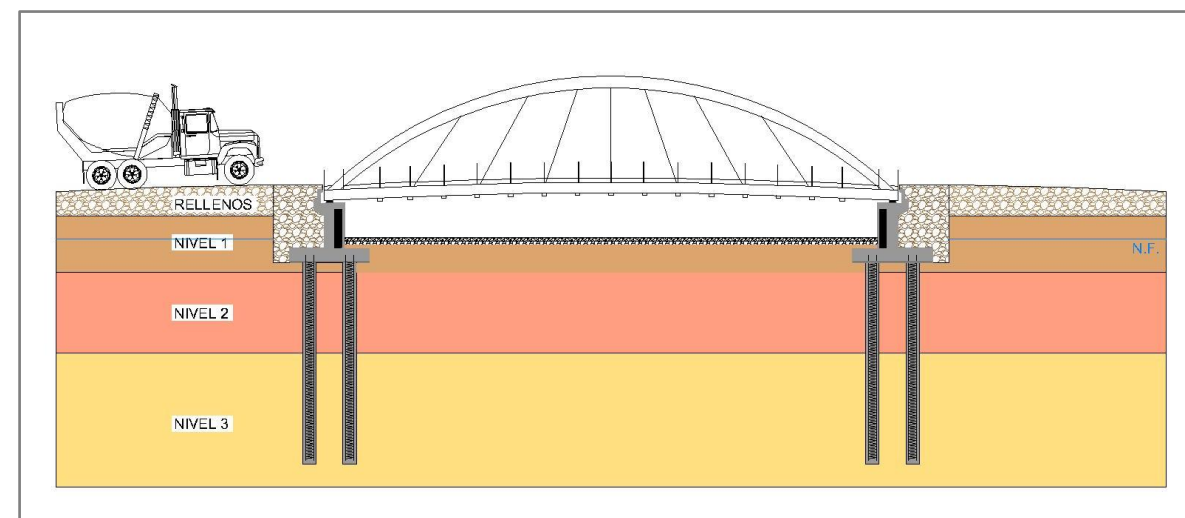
Encofrado, ferrallado y hormigonado de la losa estructural.
